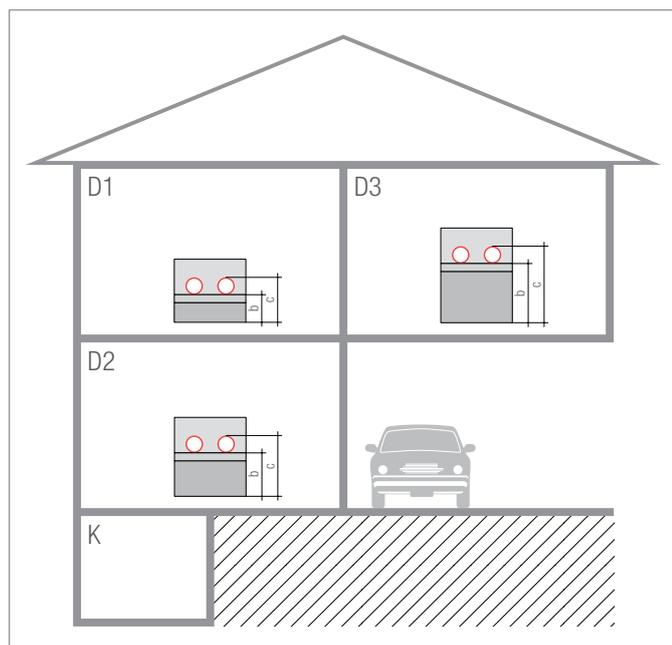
Structures de couches d'isolation minimales dans le système RAUTAC 10 C Cave
